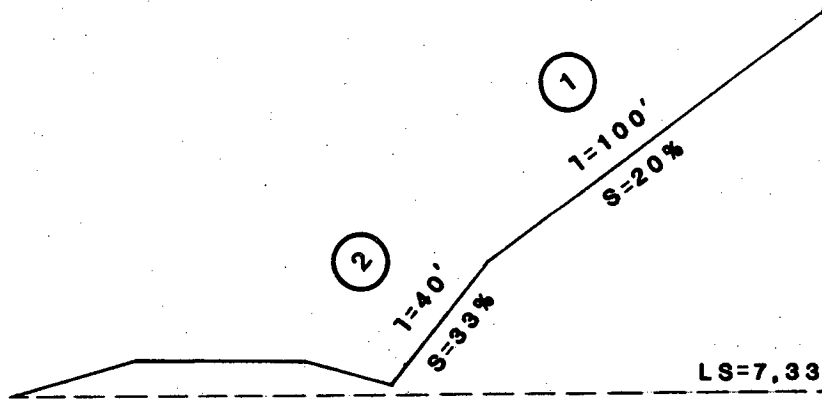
COUPE EN TRAVERS D'UNE ROUTE
